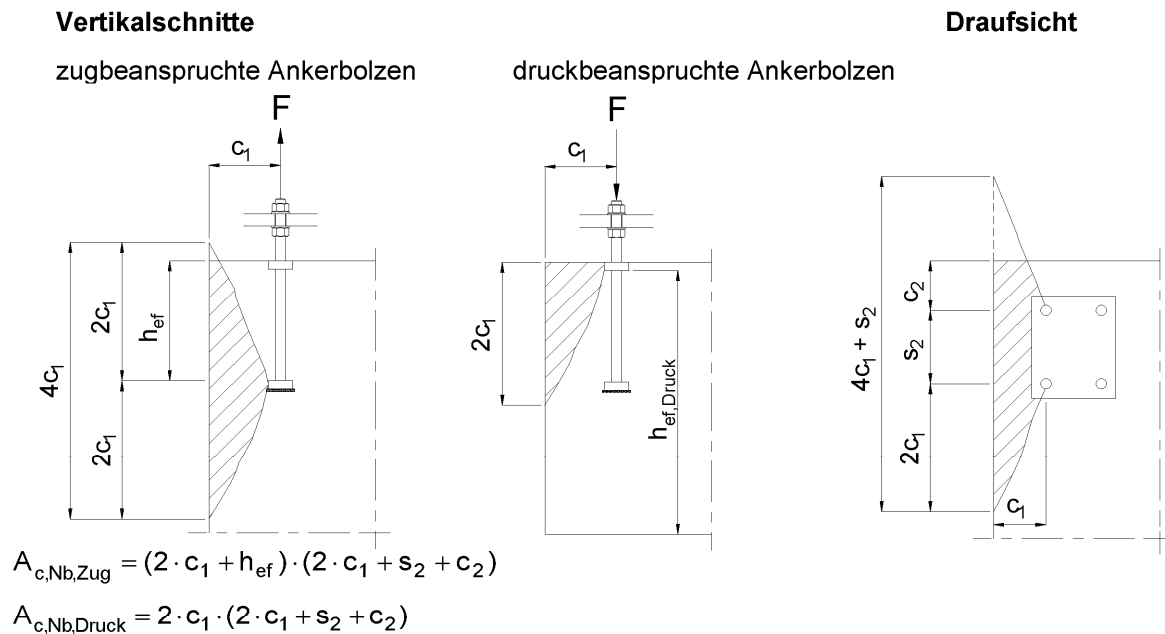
Beispiel für lokalen Betonausbruch am Bauteilrand
